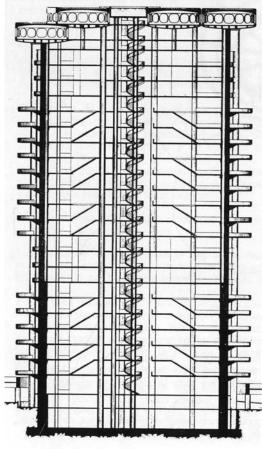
Pantallas en C en el contorno de la planta (Estructura 1970)
